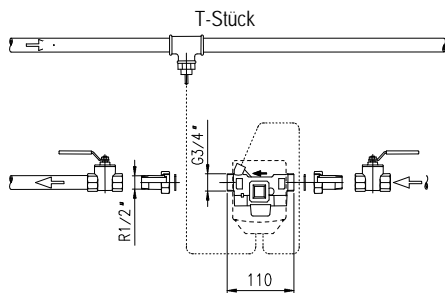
Beispiel für Einbindung mit T-Stück und Zähler mit 110 mm-Armatur
